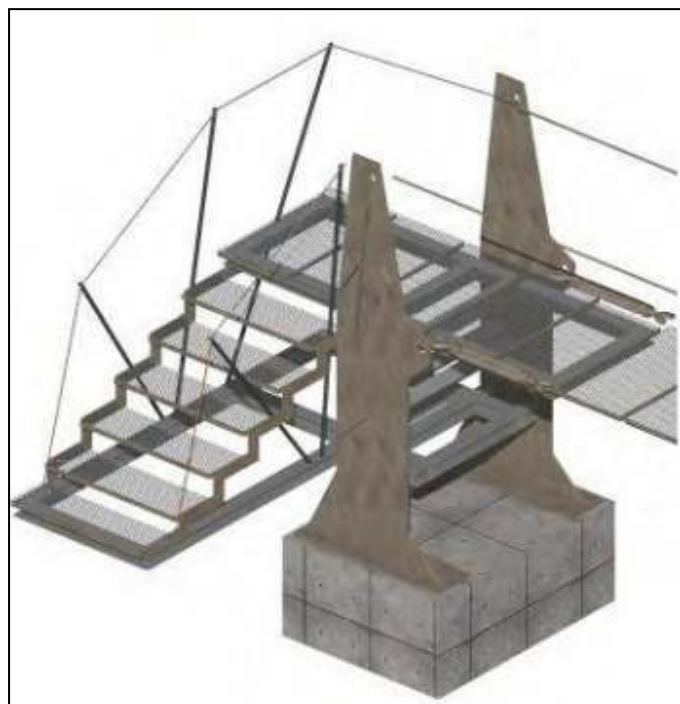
Vista assonometrica delle spalle della passerella
